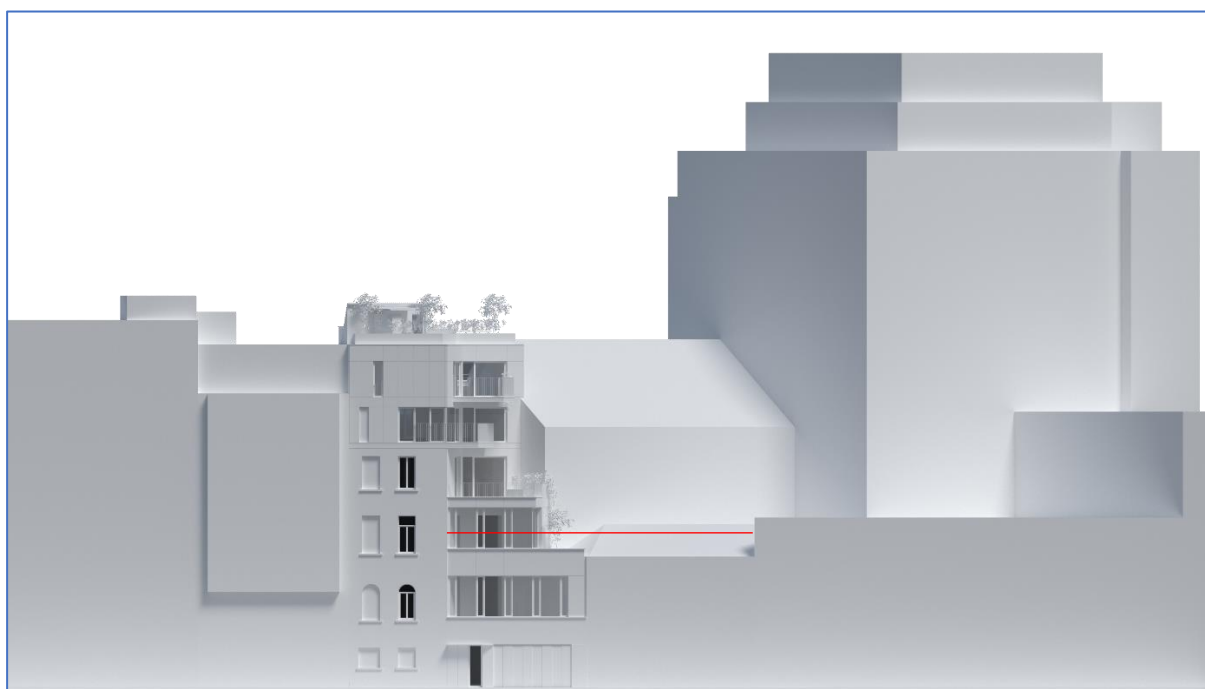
Élévation arrière projetée sur la rue de la Charité : Alignement avec la façade du musée Charlier
